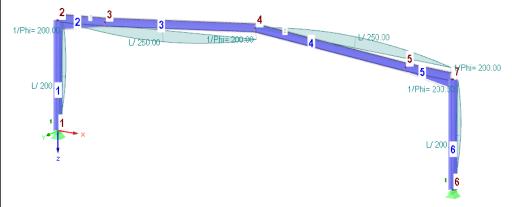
Imperfecciones para pilares y vigas horizontales
